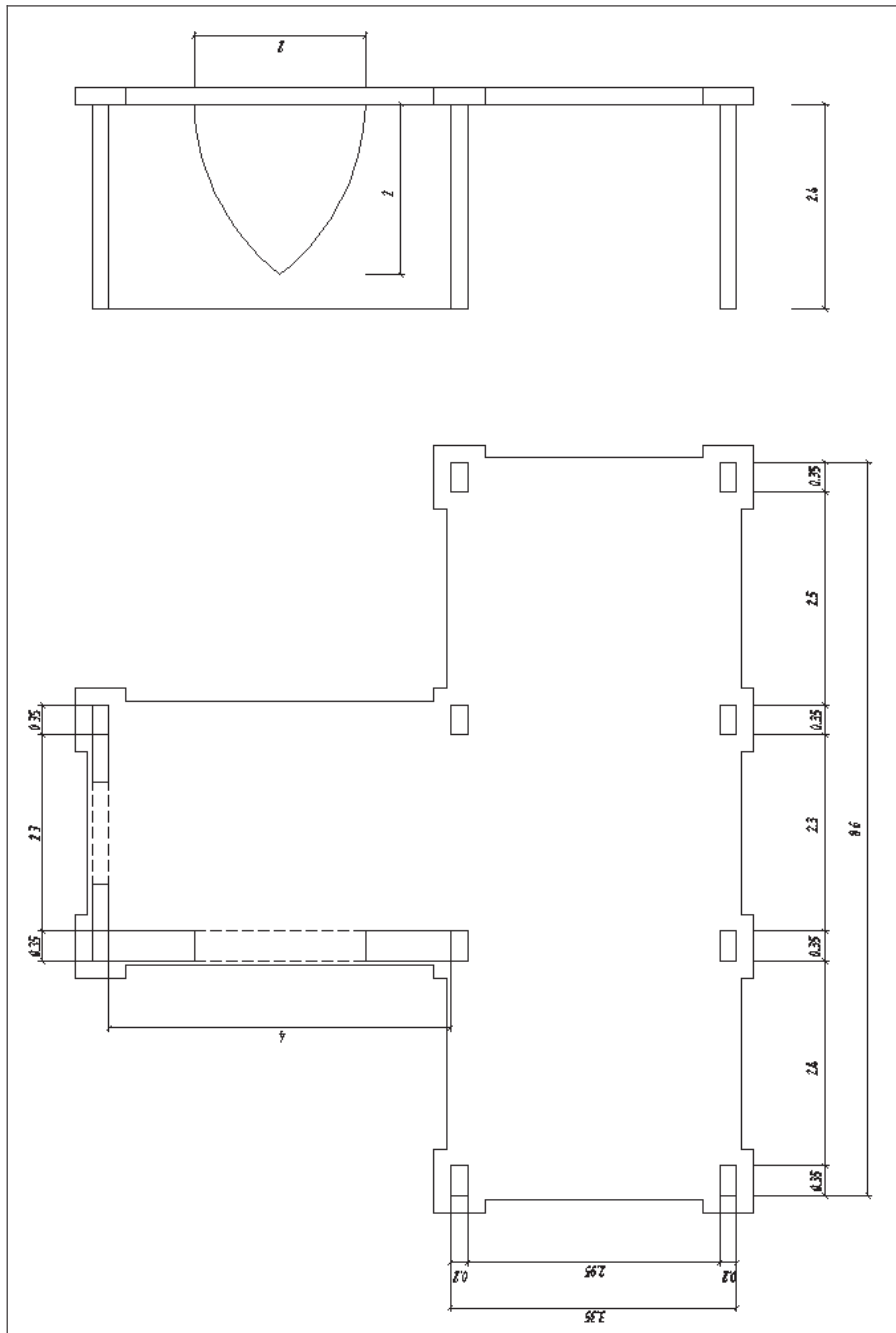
Pianta e prospetti della struttura oggetto della sperimentazione
